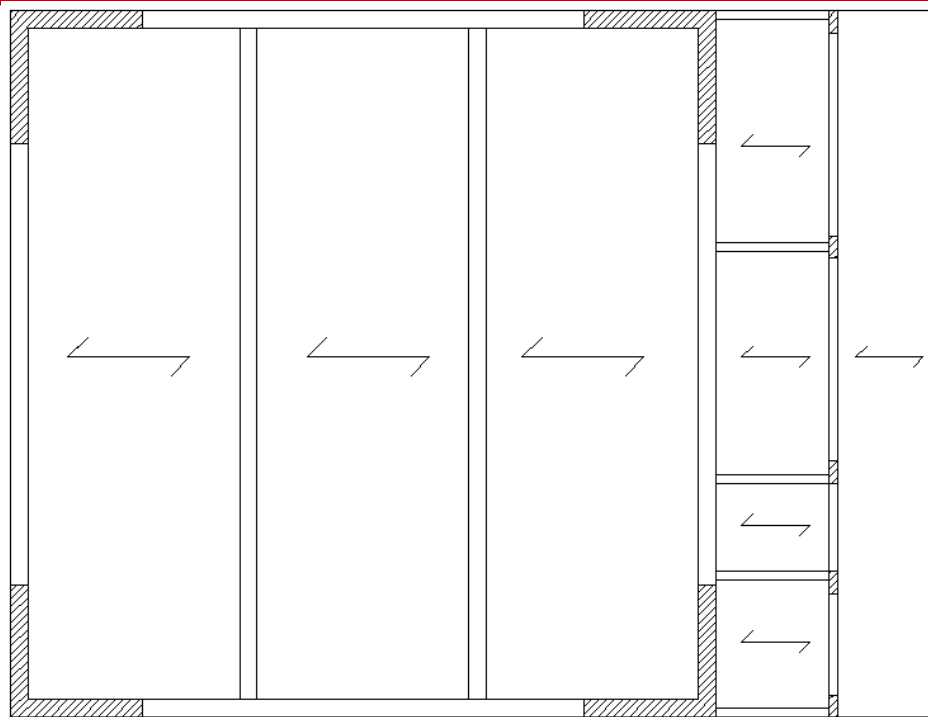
Plano de planta opción Aligerado convencional con vigas intermedias
